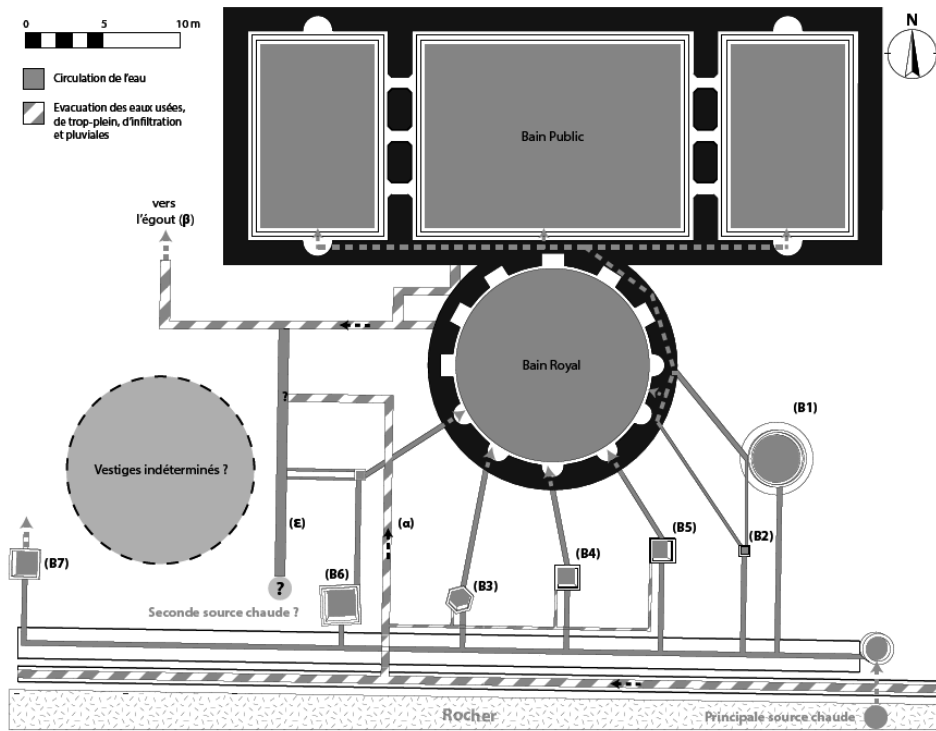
Planimetria dell'impianto termale di Bourbon-Lancy (da VURPILOT 2014, p. 136).
